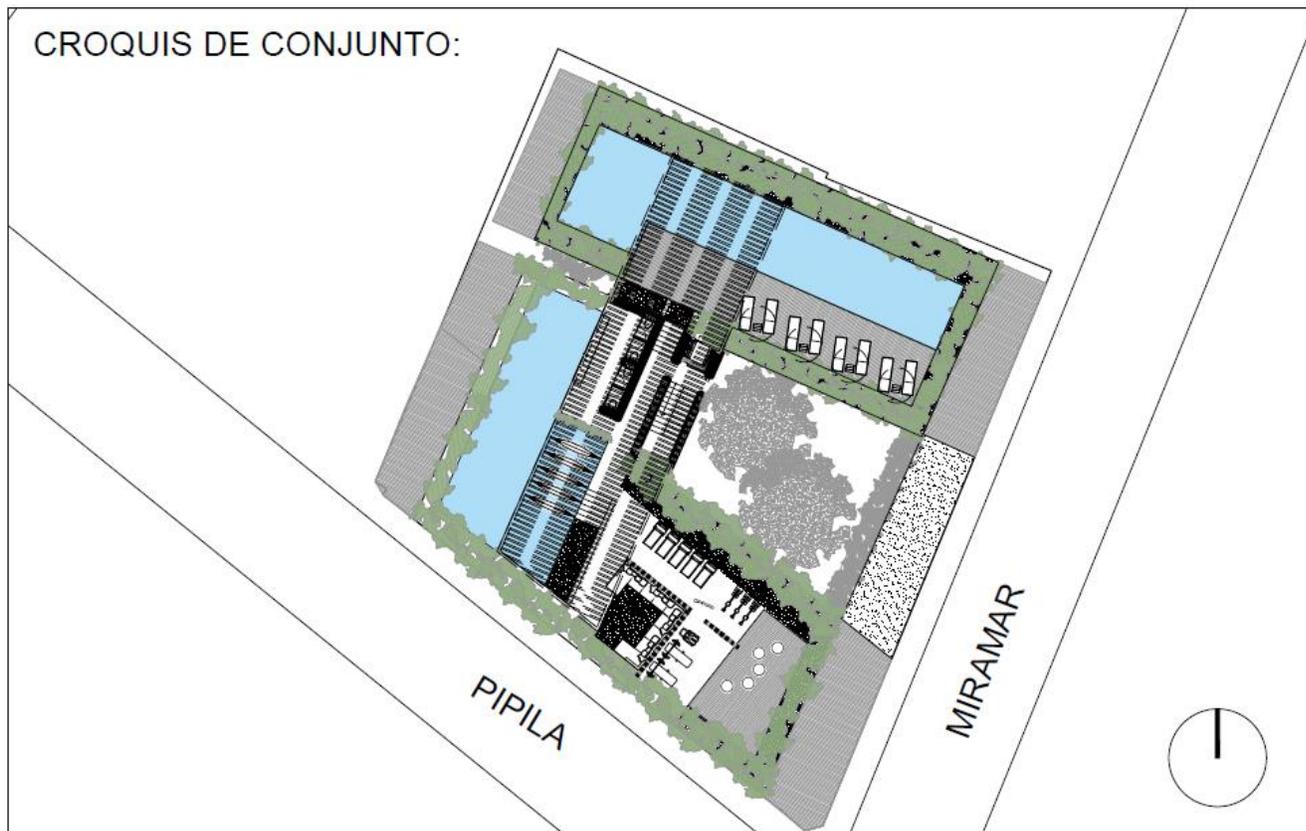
Planta de conjunto. Fuente: Plano Arquitectónico.
